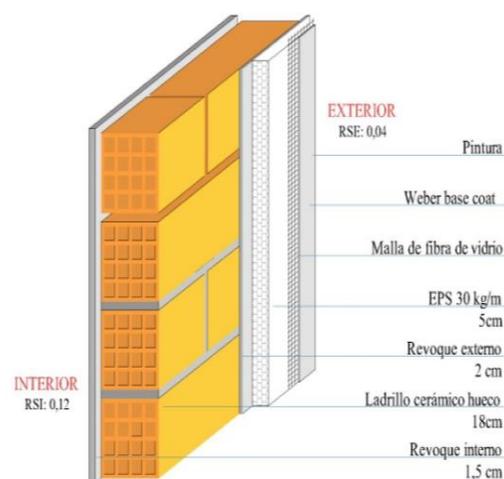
Muro Termo acústico con fibra de vidrio.
